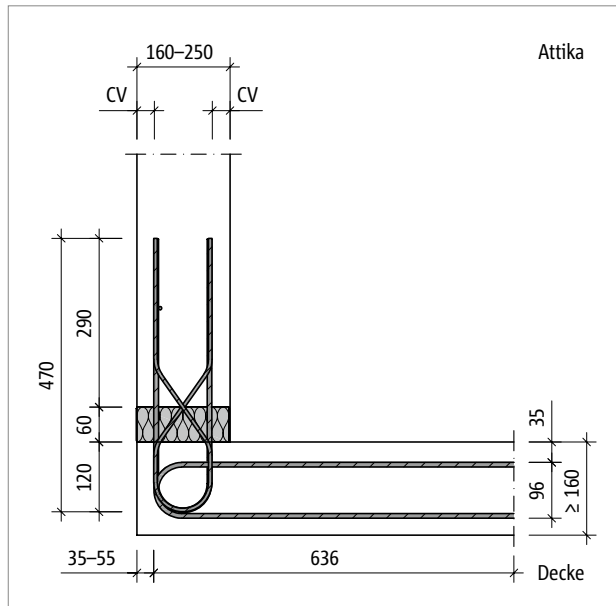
Schöck Isokorb® T Typ A-MM1-X60: Produktschnitt
